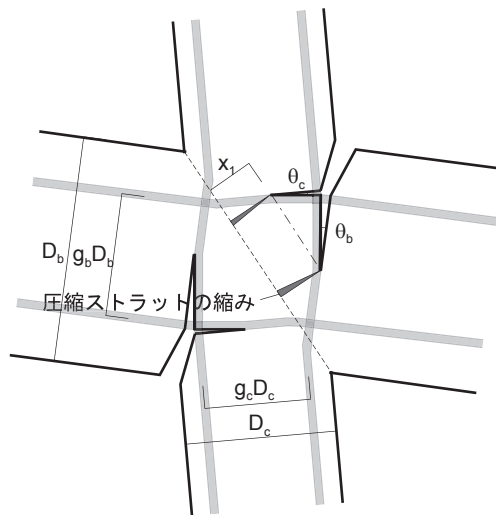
ひび割れ発生時の柱梁接合部の変形
